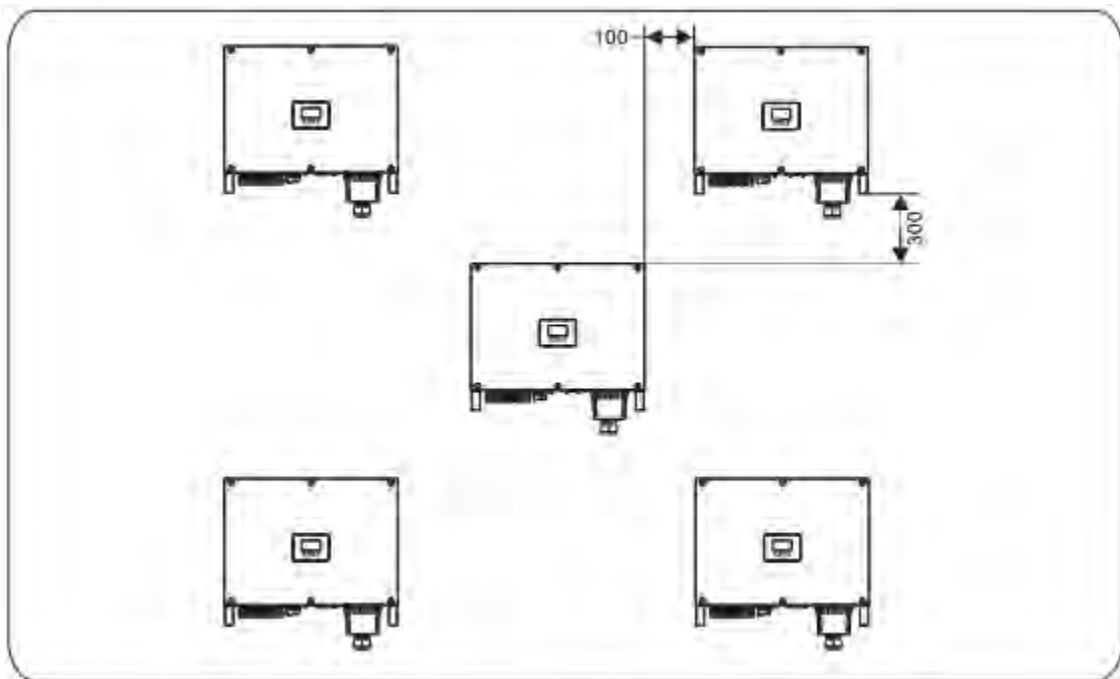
Installazione in modalità triangolo (unità: mm)
